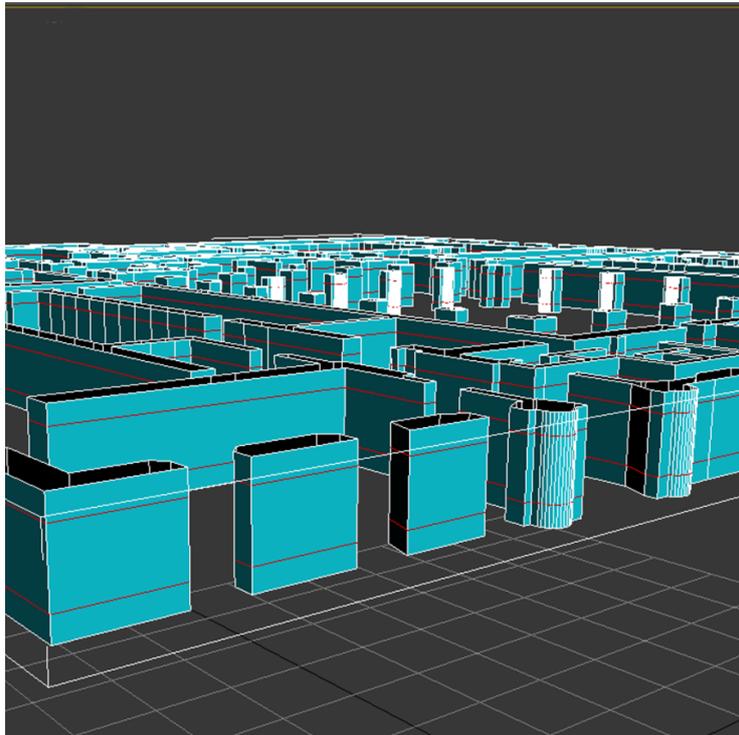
Plano extruido y dividido horizontalmente en 3 partes
